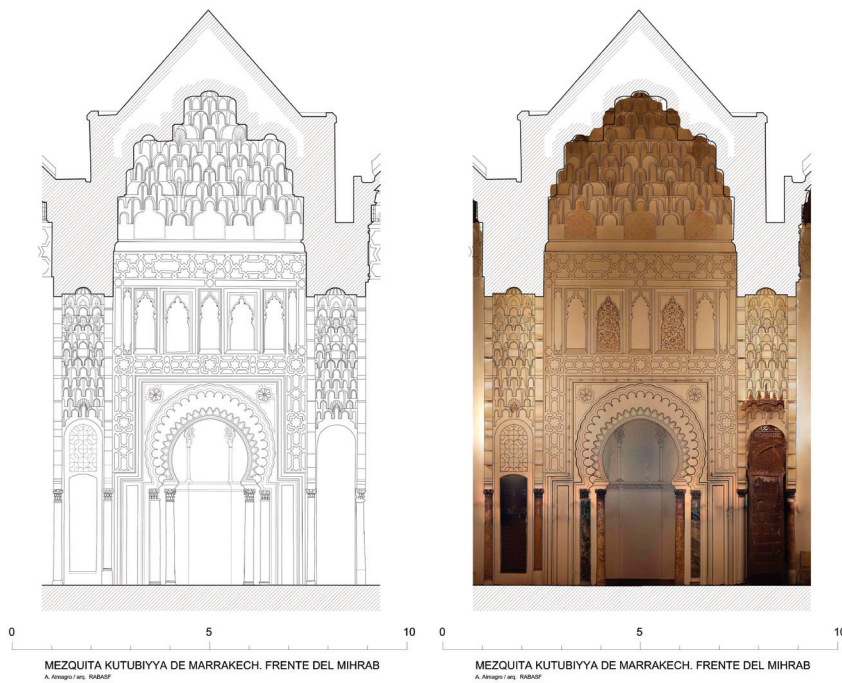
Alzado de la fachada del mihrab de la mezquita Kutubiyya de Marrakech (Marruecos) en dibujo de línea y con ortoimagen.
